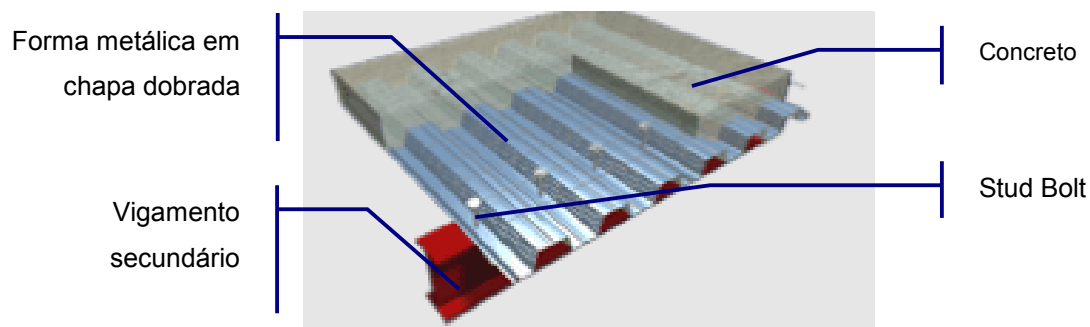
Laje *Steel Deck* (METFORM, 2006)
